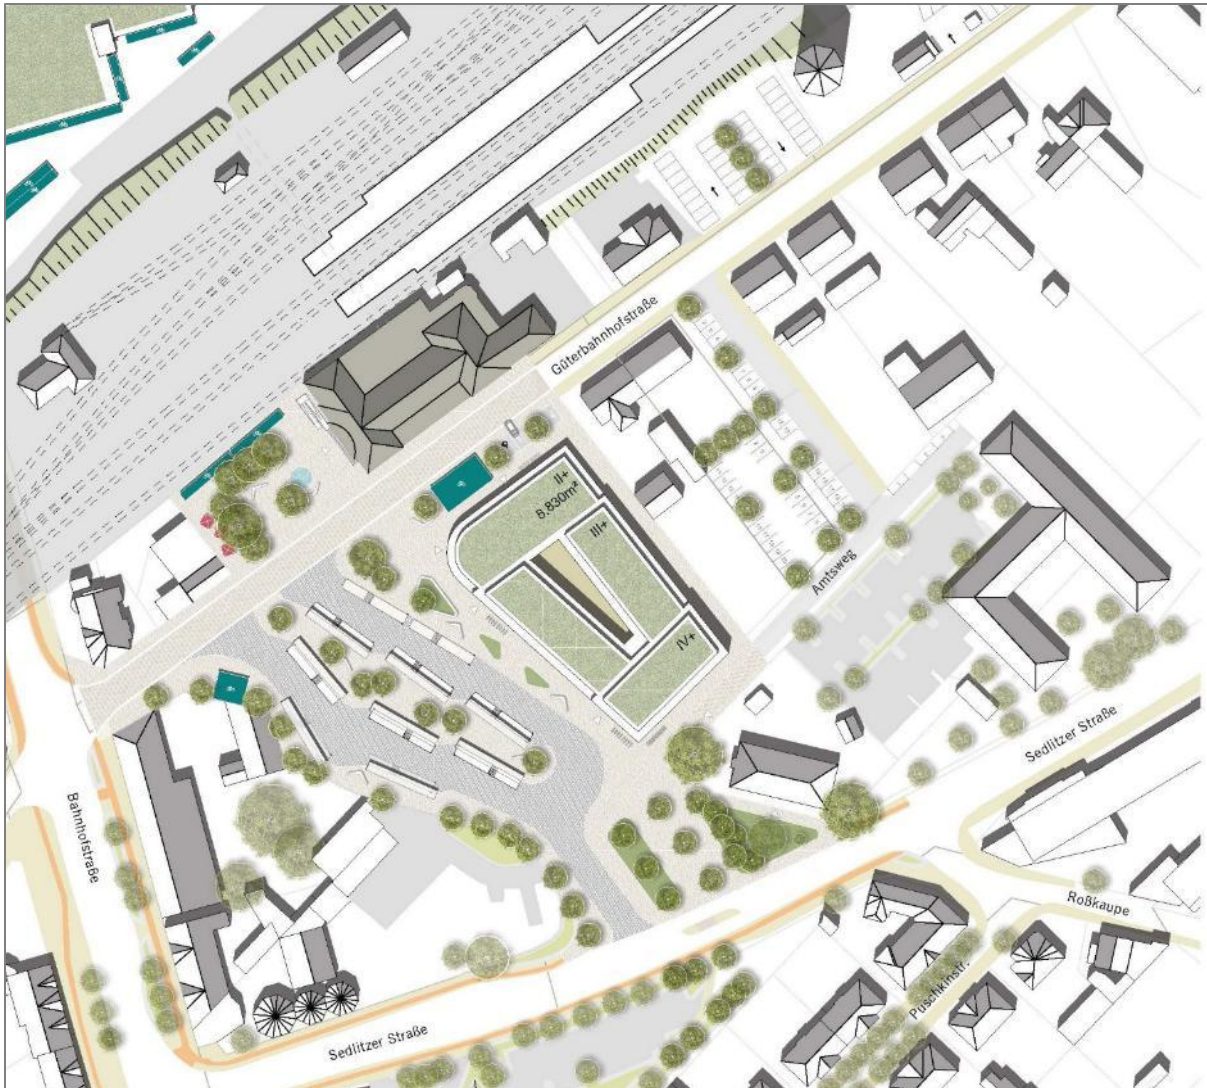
Vorzugsvariante zur Umgestaltung aus dem Rahmenplan, 2025, Quelle: GRUPPE PLANWERK aus dem Rahmenplan.
